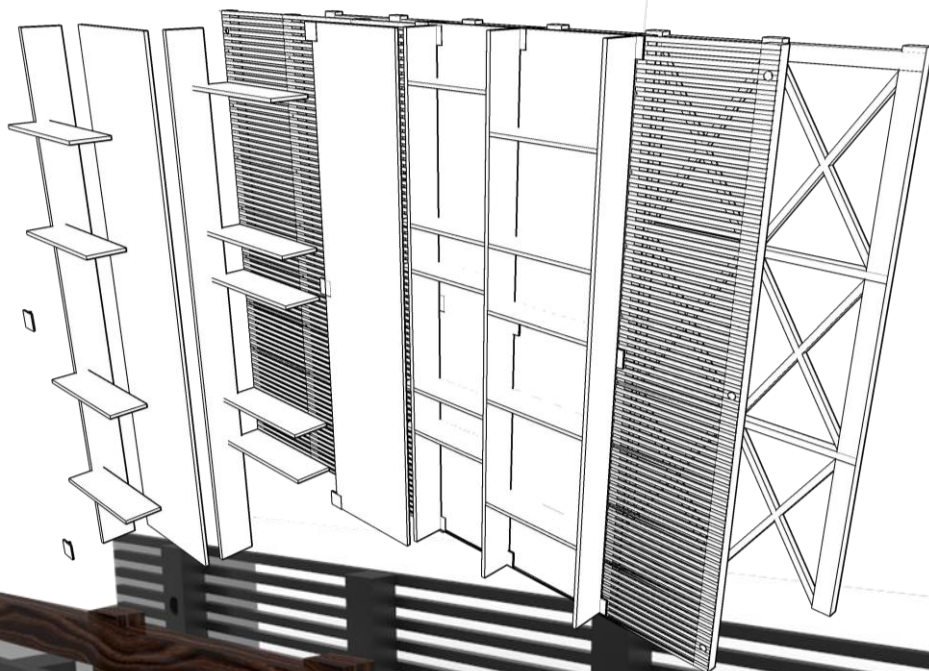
Render's expositivos de esquema de procedimento dos painéis verticais transparentes para paredes, autoria do autor.
